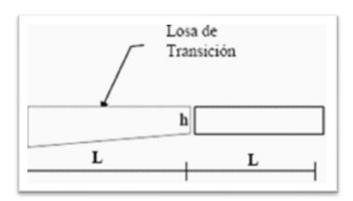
Transición entre pavimento nuevo y existente Fuente: Elaboración compañía GESCO S.A.S
